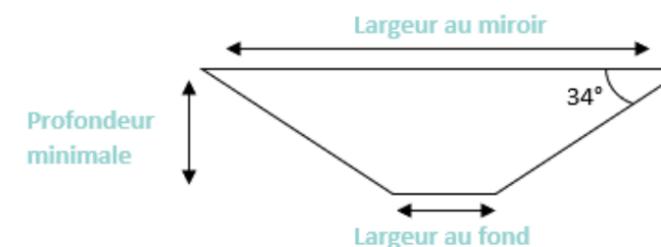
Dimensionnement des ouvrages (noues et bassins)
